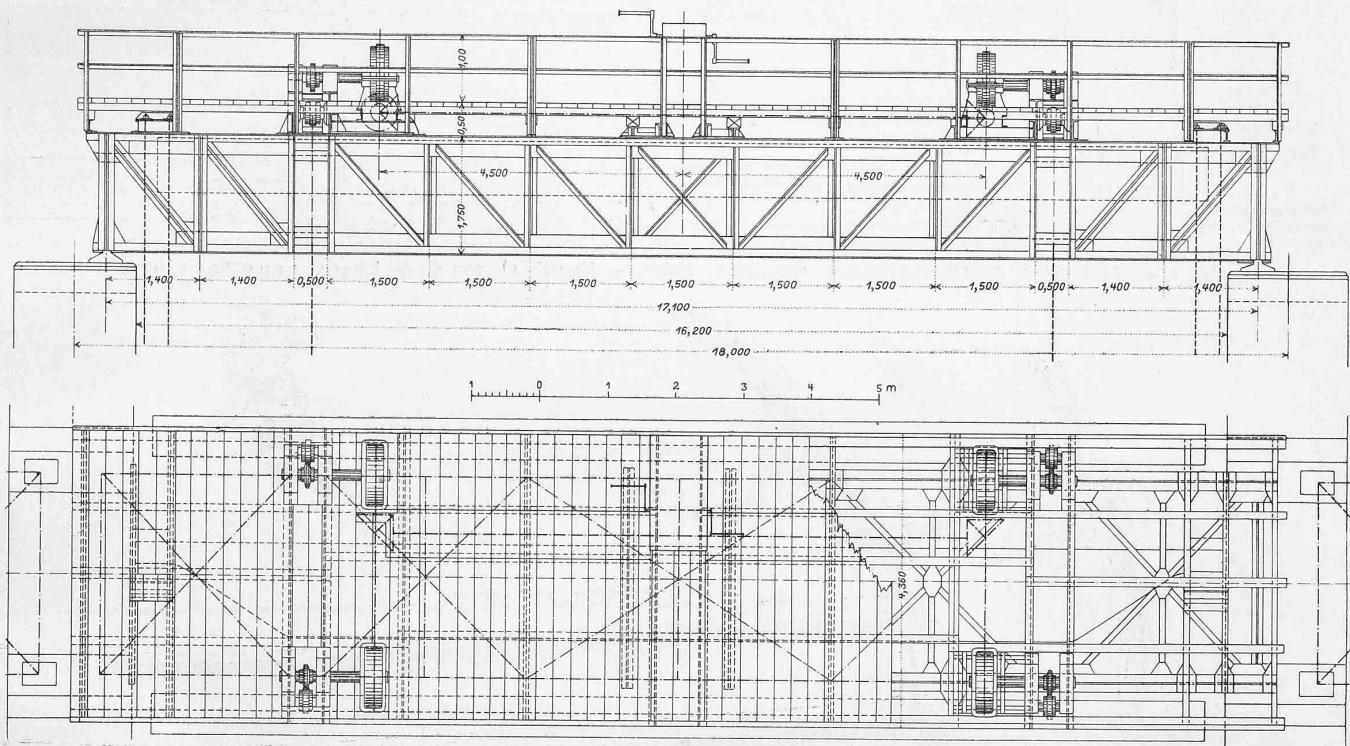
Ansicht und Draufsicht der Dienstbrücke des Stauwehres über einer Wehröffnung. — Masstab 1:100.
